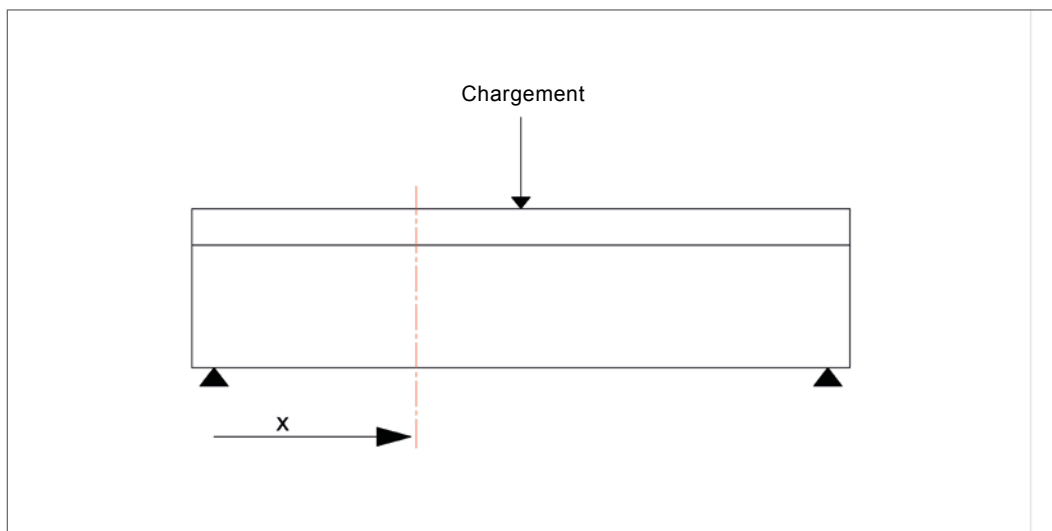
Étude d'une section située à l'abscisse x d'une poutre mixte
